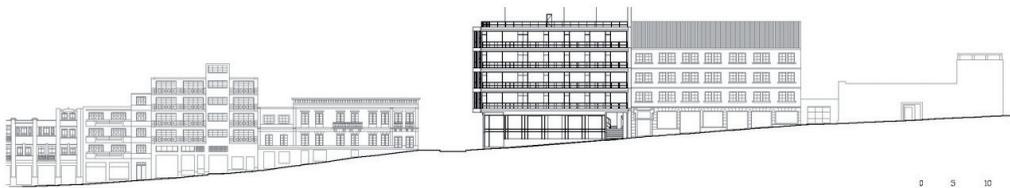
Alzado frontal de la Dirección Provincial de Salud sobre la calle Mejía
